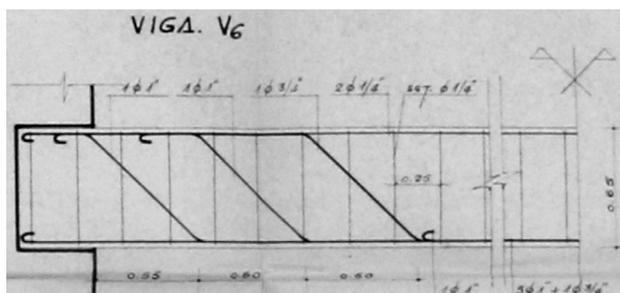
Corte longitudinal da viga V6 (excerto do projeto original) [10].
